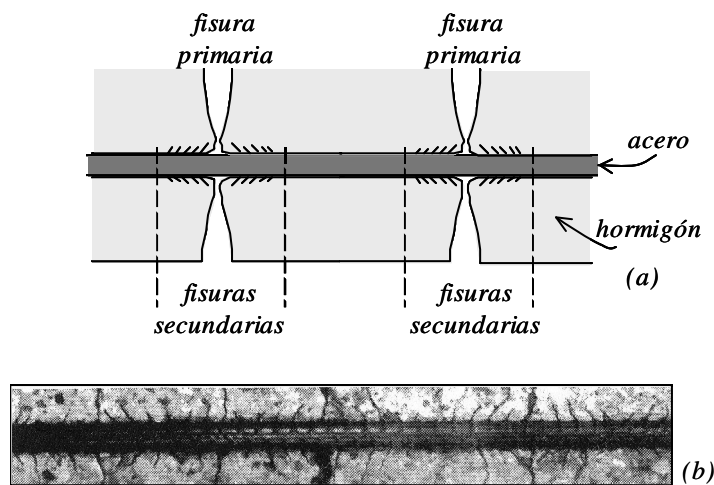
Esquema de la respuesta estructural típica en hormigón armado: (a) en vigas con poco refuerzo (Ruiz, Elices et al. 1998), (b) en probetas con refuerzo homogéneo sometidas a tracción (Ouyang, Wollrab et al. 1997).
